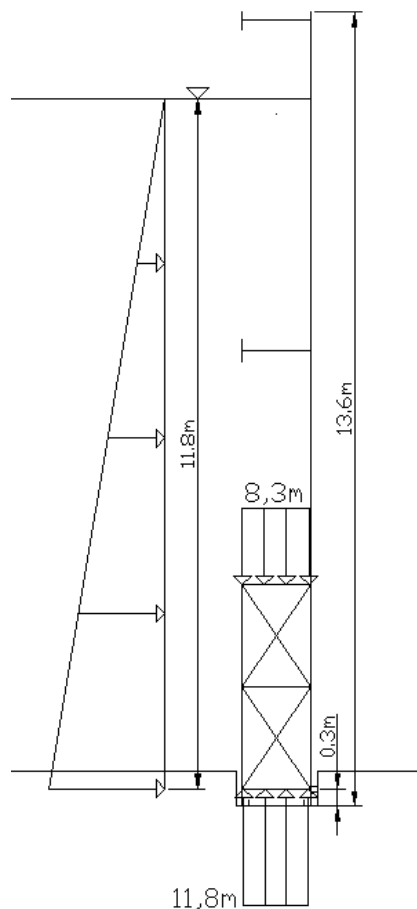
Figure II-III : Cas de chargement C3 (bief aval à sec) pour une porte aval avec caissons étanches
